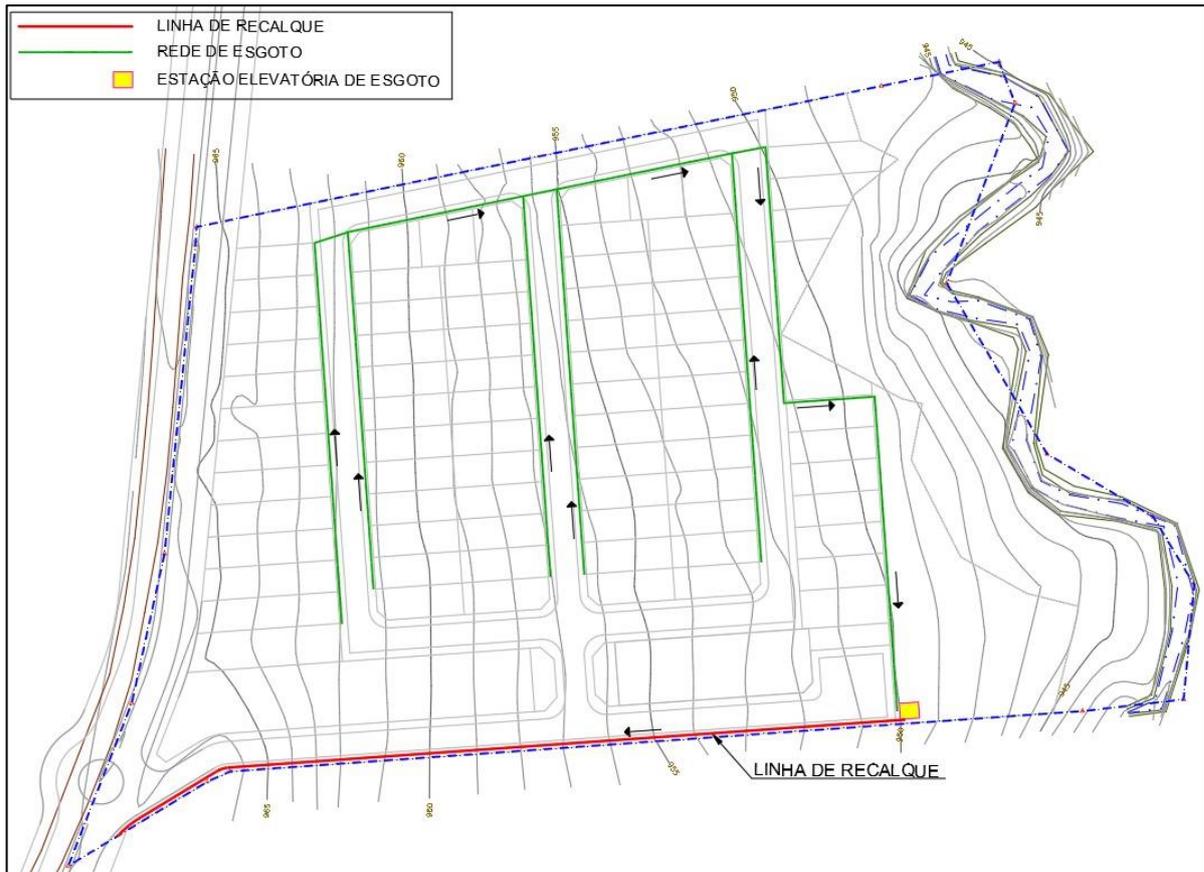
Traçado 02 Proposto para Rede de Esgoto (Alternativa 01).
